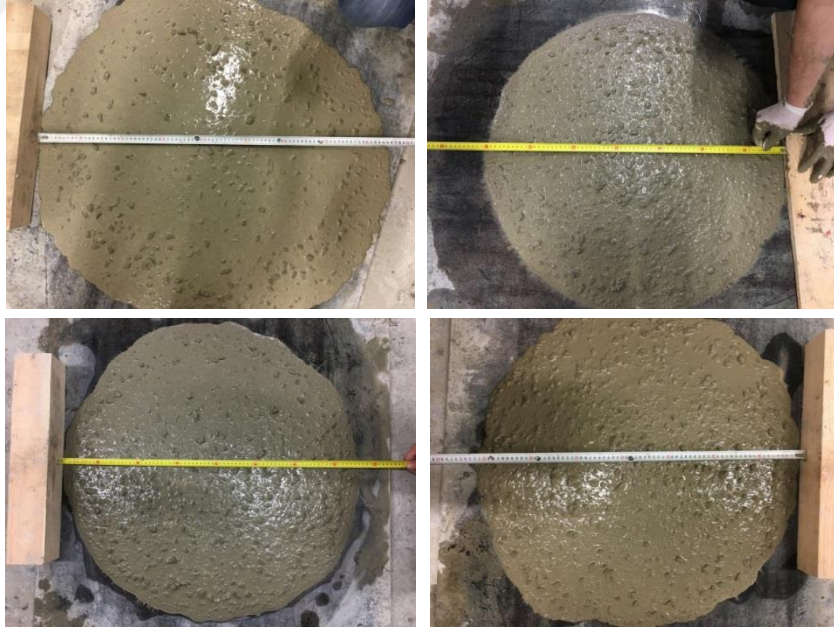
’de ise soldan sağa doğru doğru 350-0, 350-36, 350-72 ve 350-108 kodlu kalker tozlu karışımlar gösterilmiştir.
